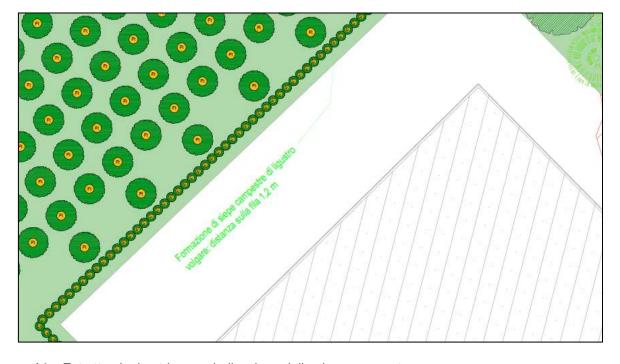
Estratto planimetrico con indicazione della siepe campestre
